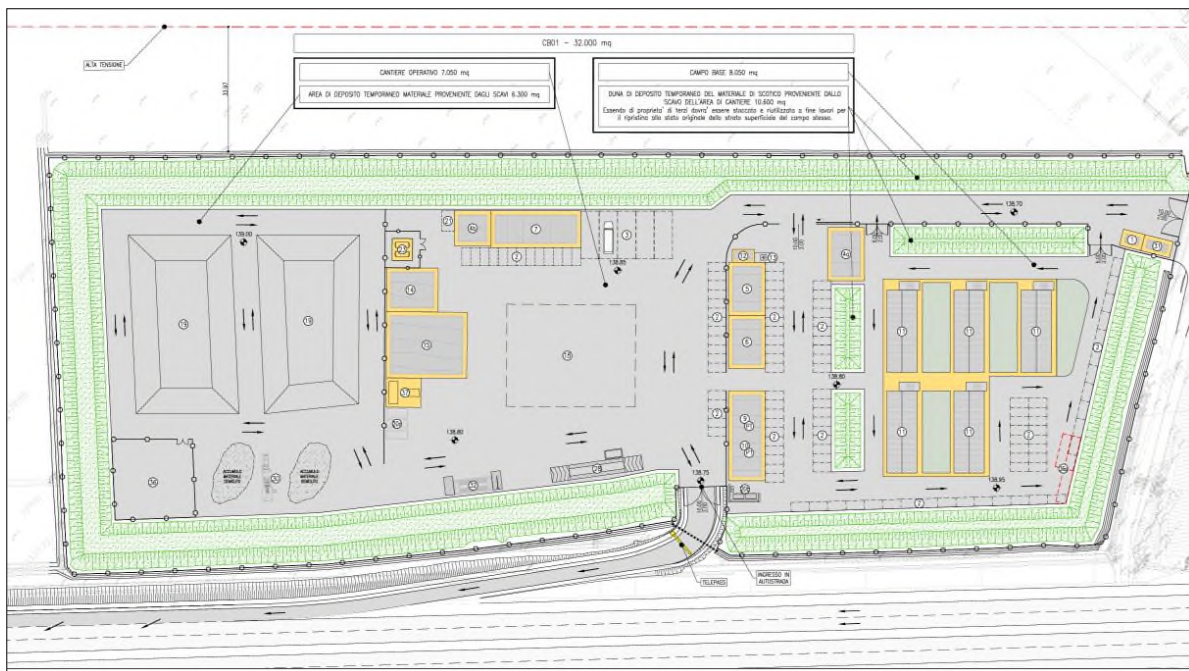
Stralcio planimetrico dell'area di cantiere CB01, nel Lotto 2
